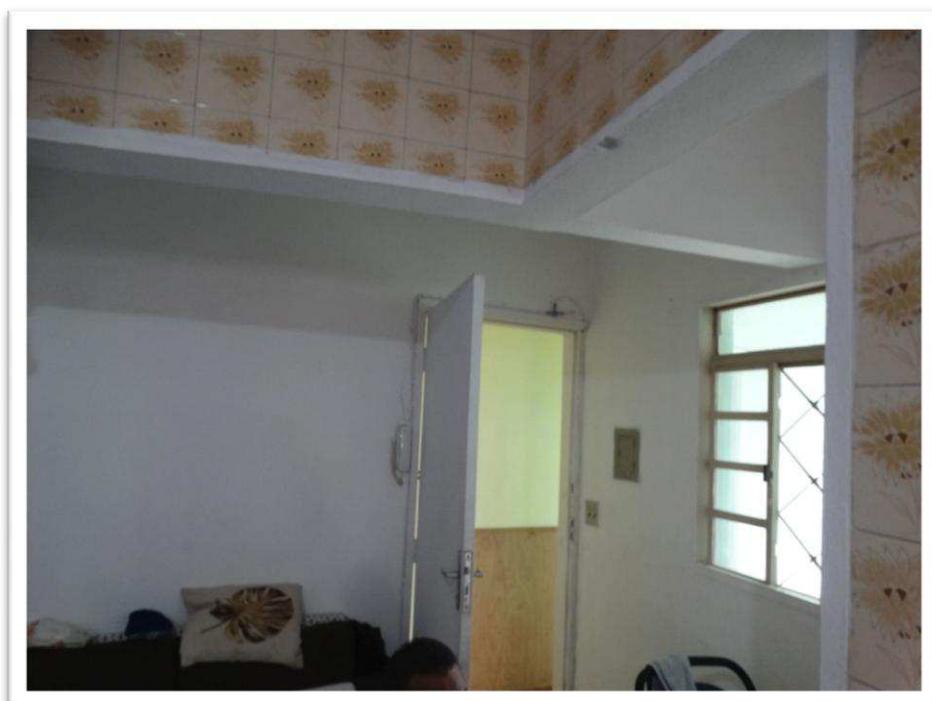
Vista parcial do interior de um dos dois apartamentos do 2º pavimento.
